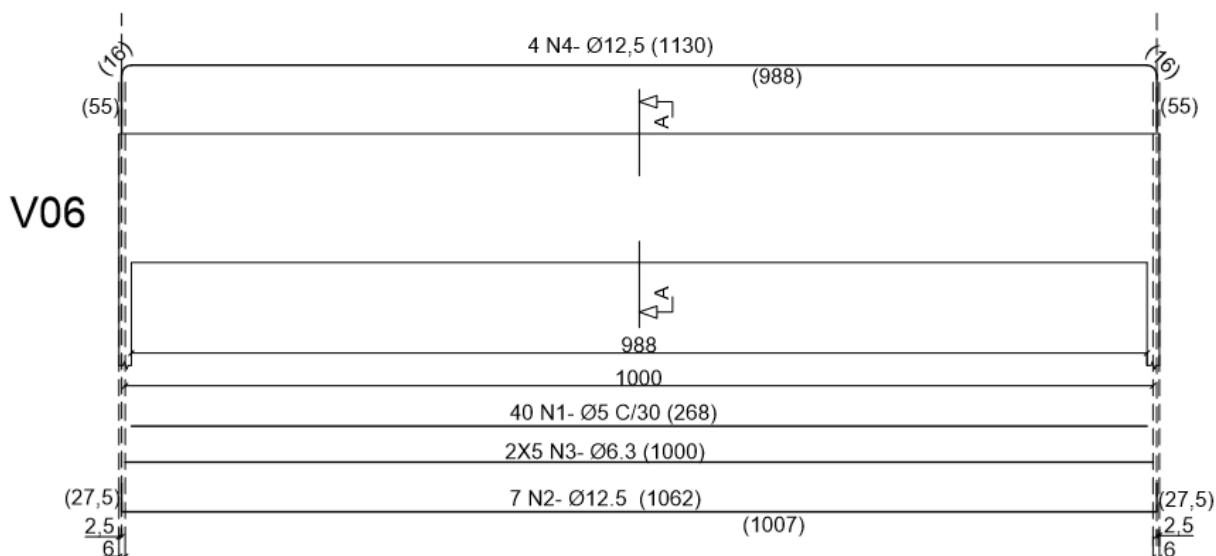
Detalhamento da viga dimensionada em concreto armado na vista longitudinal; medidas em cm; figura sem escala
